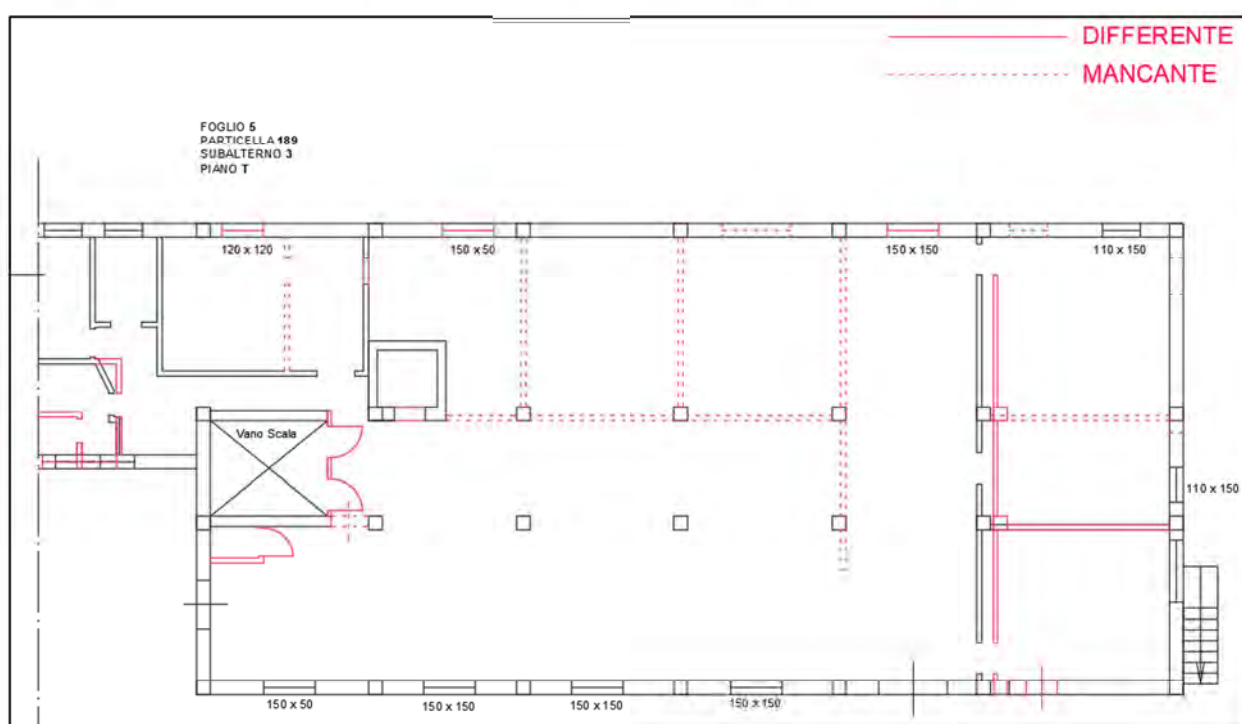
Planimetria piano terra - Differmità tra progetto in variante e stato di fatto rilevato durante il sopralluogo del 07.02.2019
